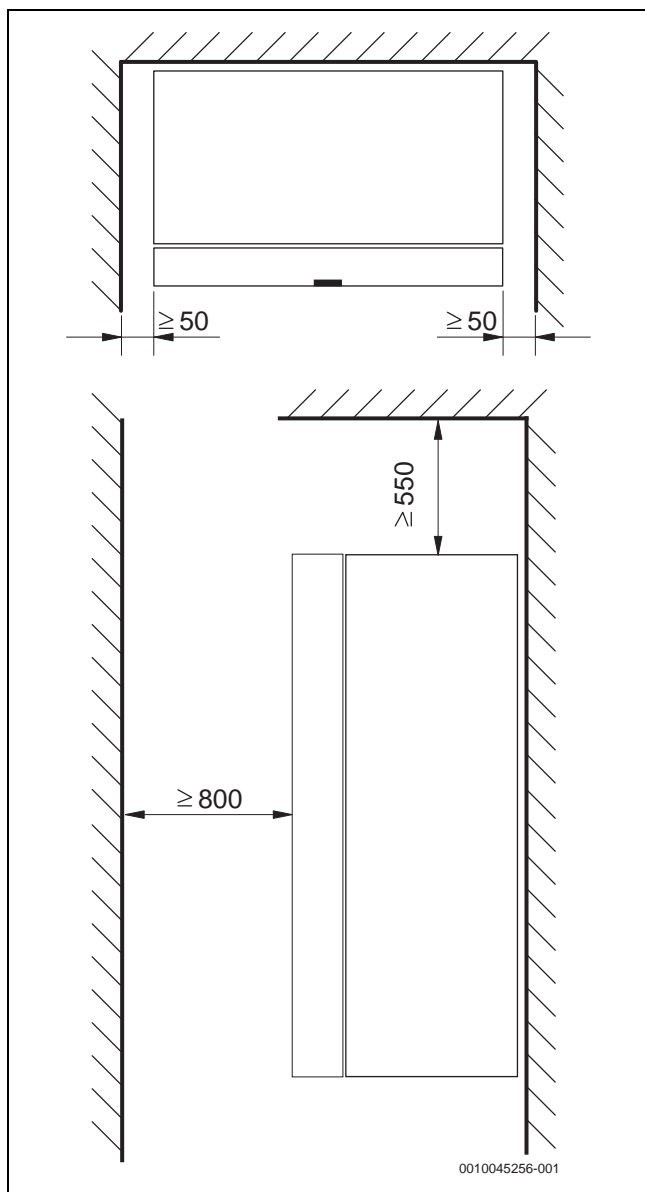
Mindestabstände zu Wänden und anderen Gegenständen (Maße in mm)
